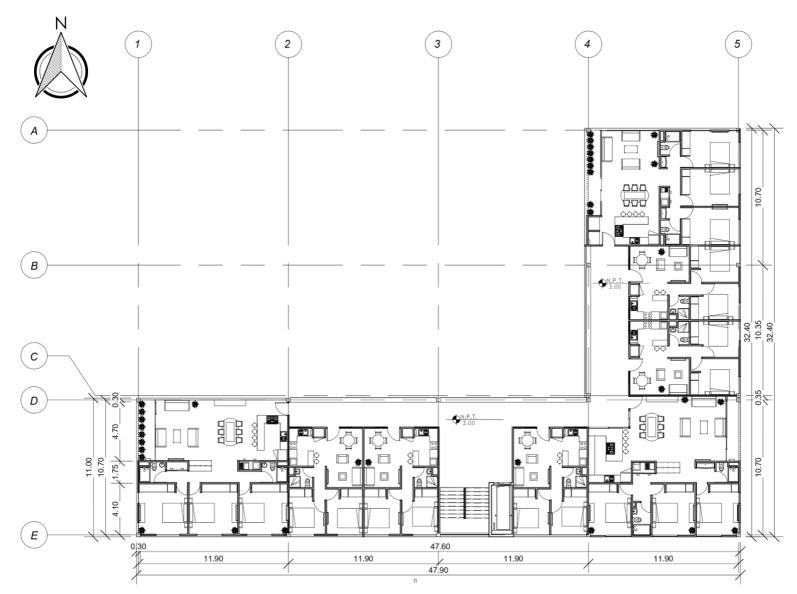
Propuesta final. Planta tipo. Elaboración propia. 2022
